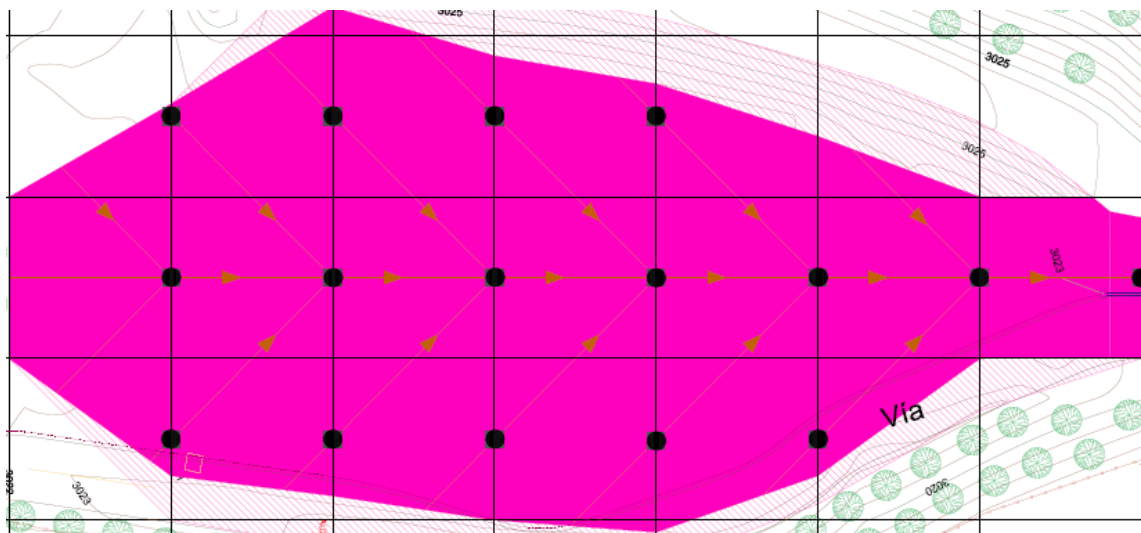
DETALLE DEL SISTEMA DE DRENAJE
